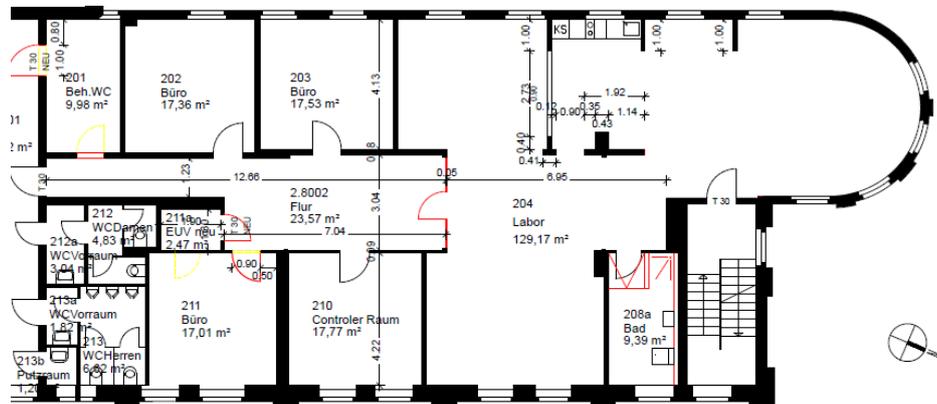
Grundriss des Living Place Hamburg
